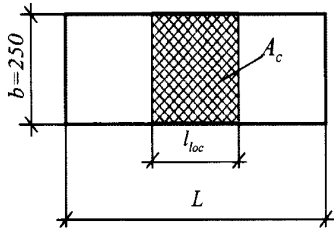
Нагрузка на средней части по всей ширине сечения стены
